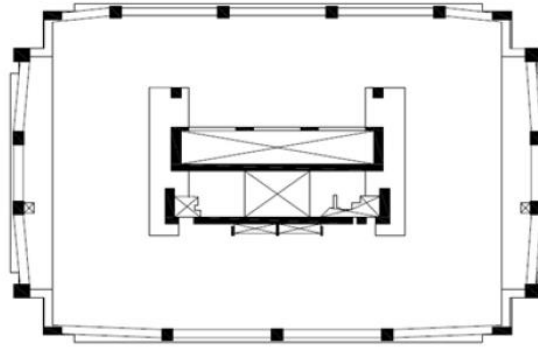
Planta Típica de Edificio de Oficinas, Lagos et. al. [40]
